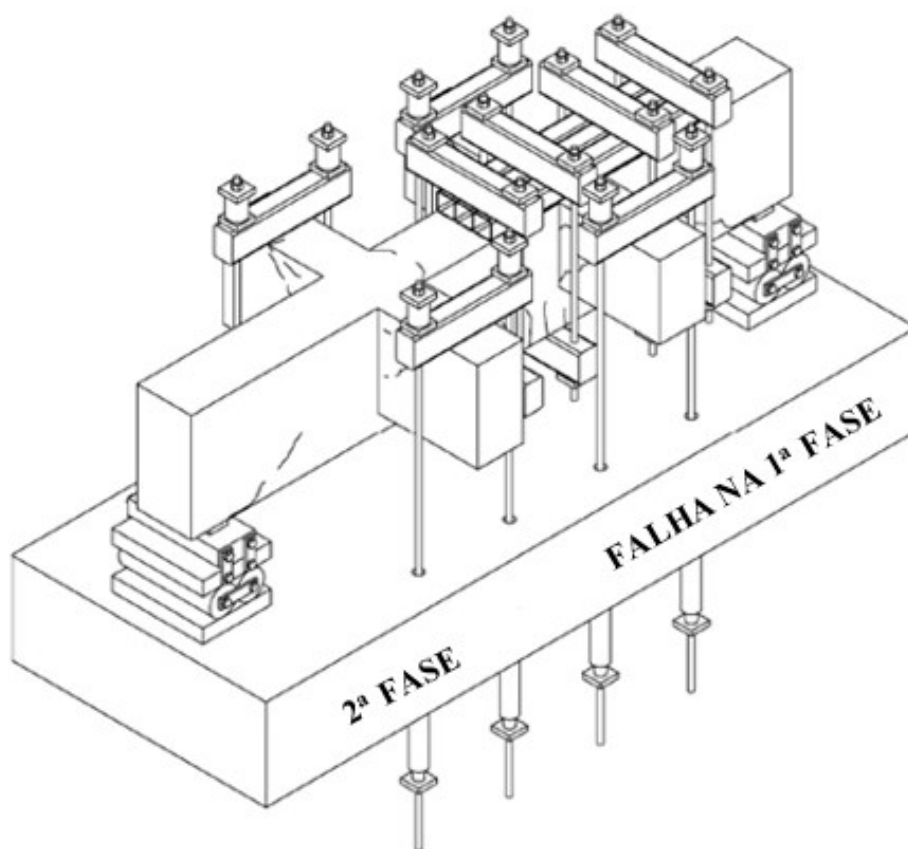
Detalhe dos carregamentos nos corpos de prova (dimensões em mm)
